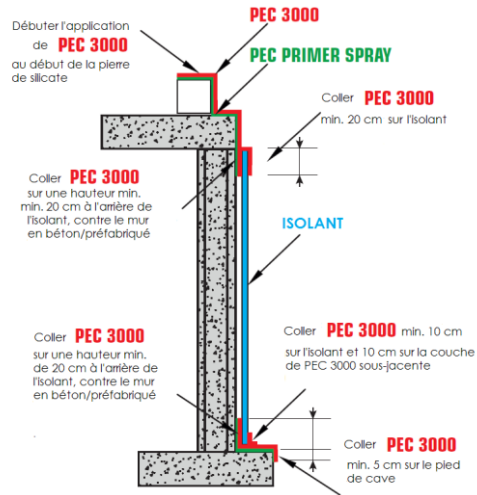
Application sur caves en béton coulé ou préfabriqué avec panneau isolant rigide
